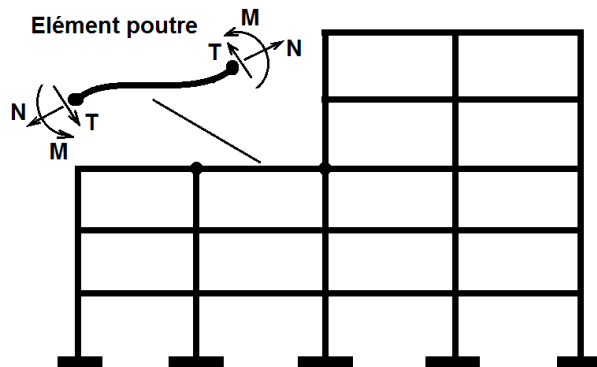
Portique (poteau-poutre) à plusieurs étages
